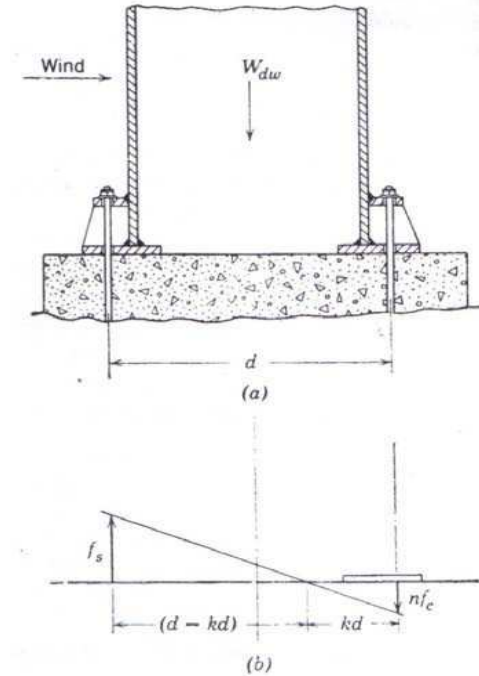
Comportamiento de las Barras de Anclaje Ante la Acción de las Cargas Actuantes [ 15 ]
